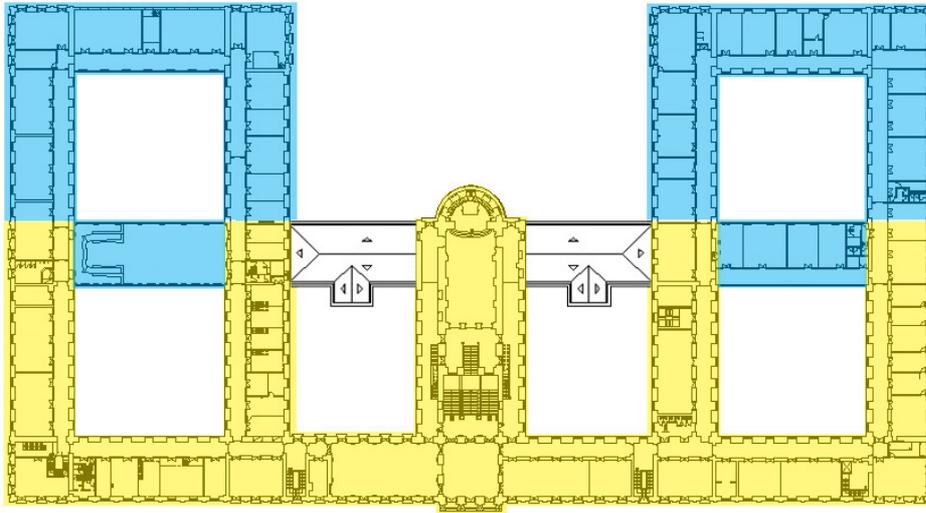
Planta do 2º pavimento, Palácio Universitário.
